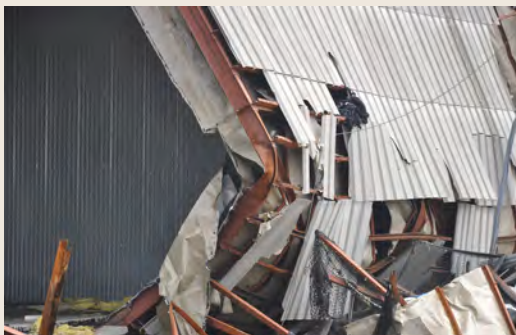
b Pandeo general por flexión en elementos de contraventeo.
